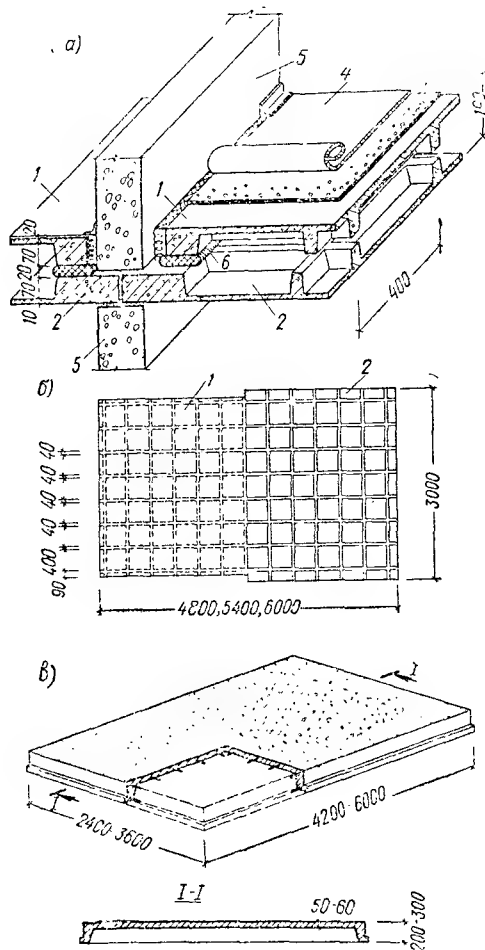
Перекрытия из ребристых и шатровых панелей
